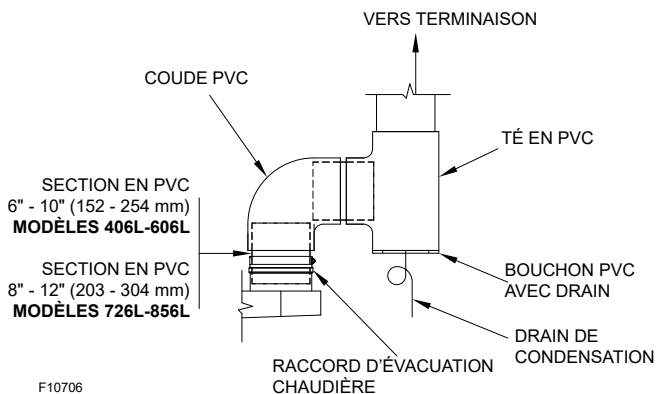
Détails de l'assemblage en PVC - Installation au chantier
